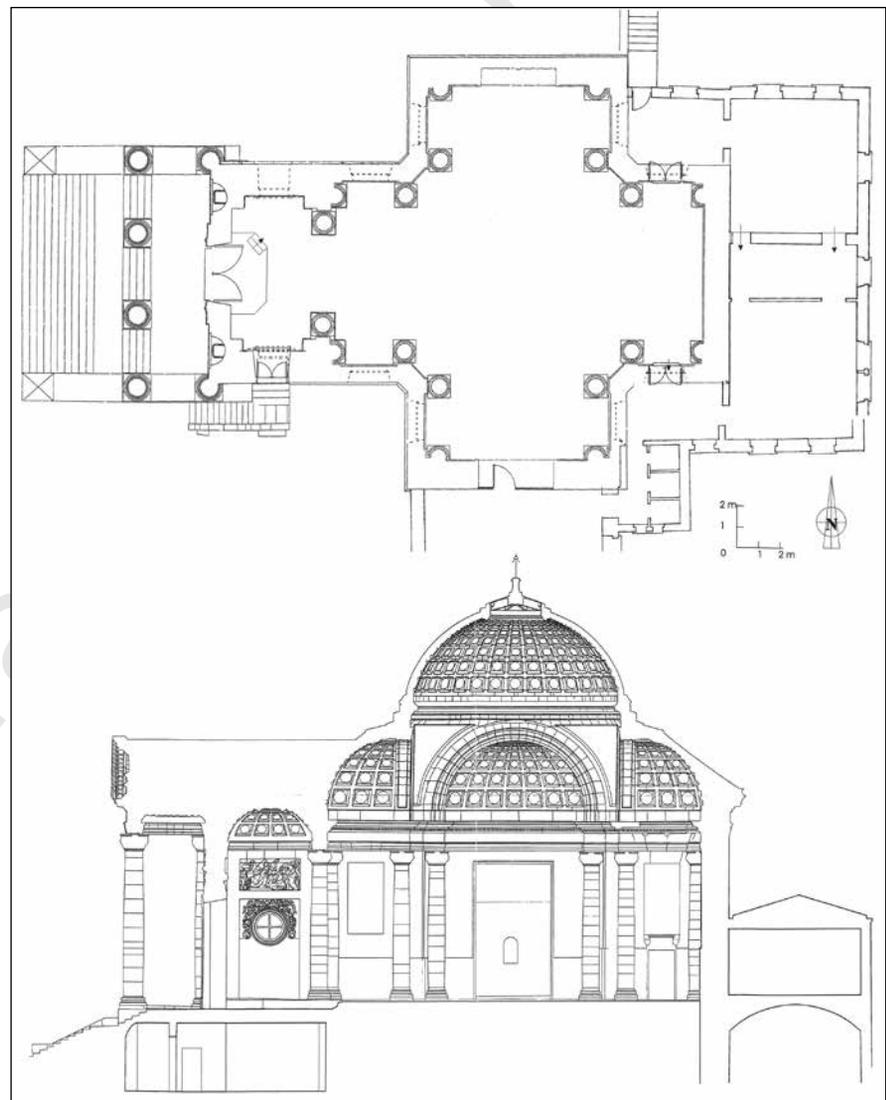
Saint-Denis, église Notre-Dame-du-Mont-Carmel, plan et coupe longitudinale (d'après Daniel Lefevre, ACMH).
